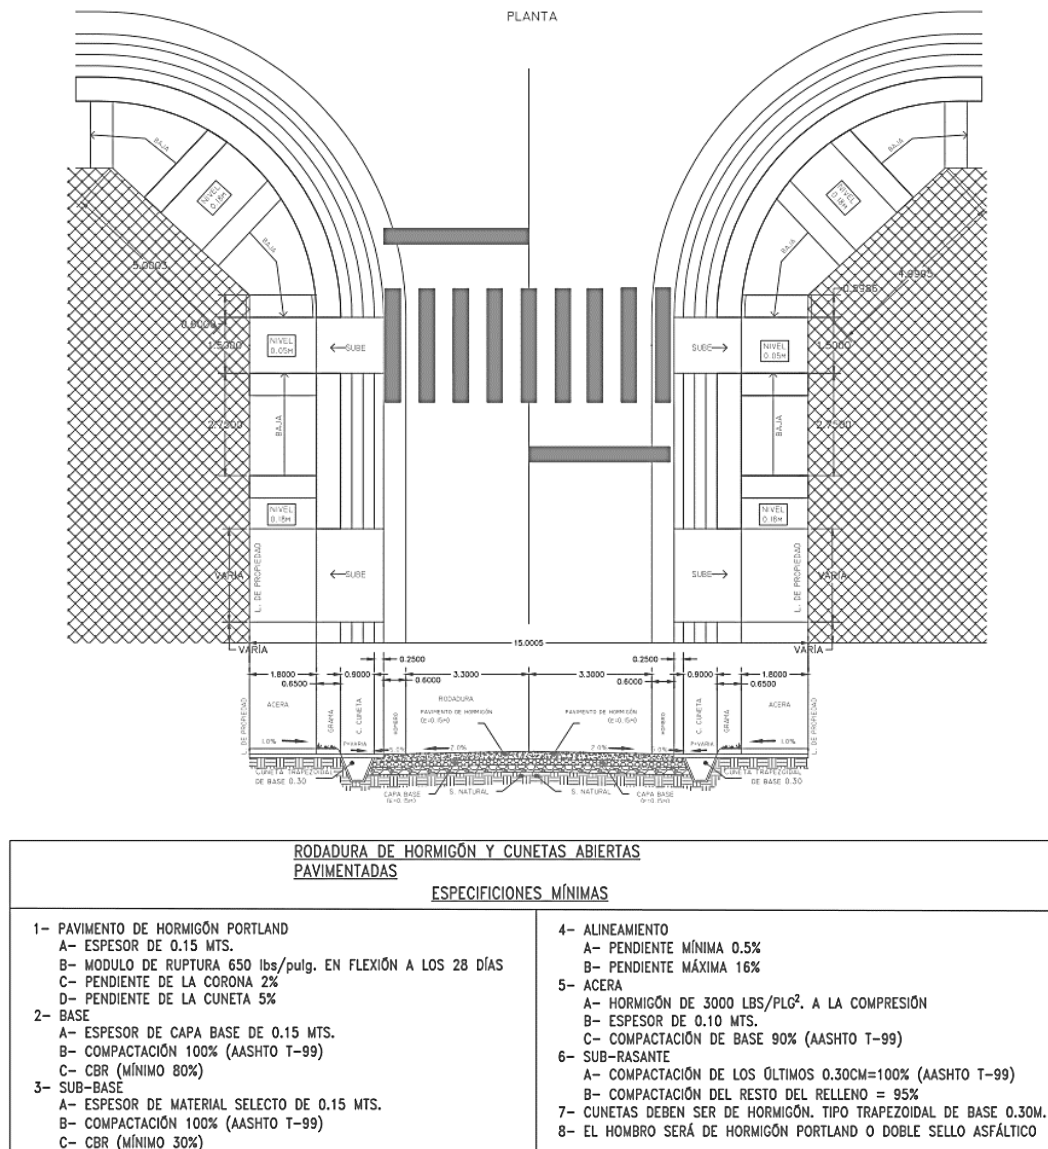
Secciones y especificaciones de calles y aceras urbanizaciones de interés social colectora/ principal (serv. de 15.00 mts.) rodadura de hormigón con cuneta abierta planta RESIDENCIAL
